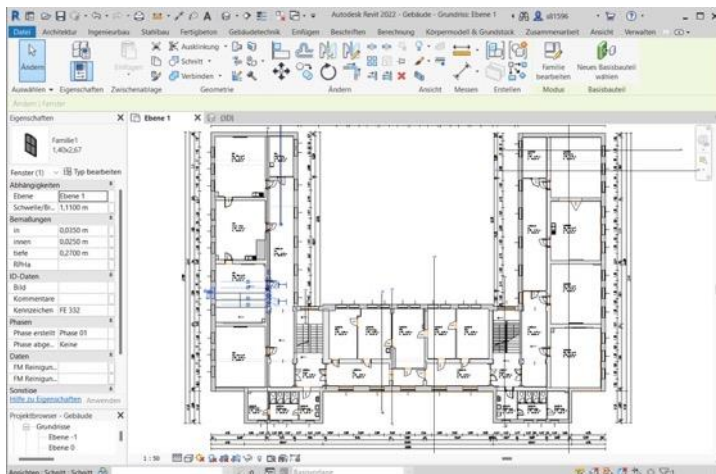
Revit, 2D-Ansicht mit Grundriss, Screenshot
